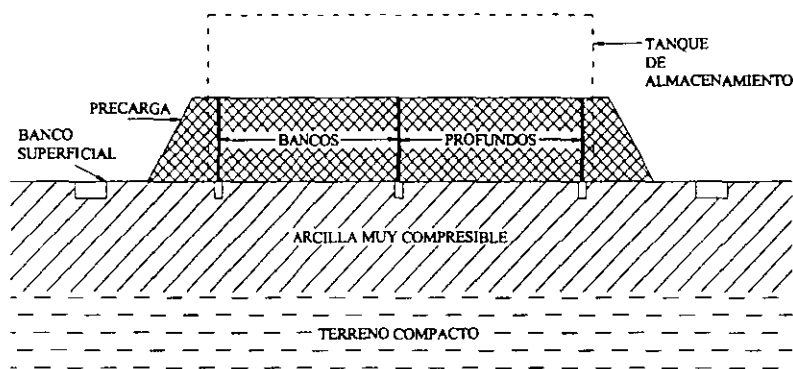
Empleo de precargas para la consolidación previa del terreno
